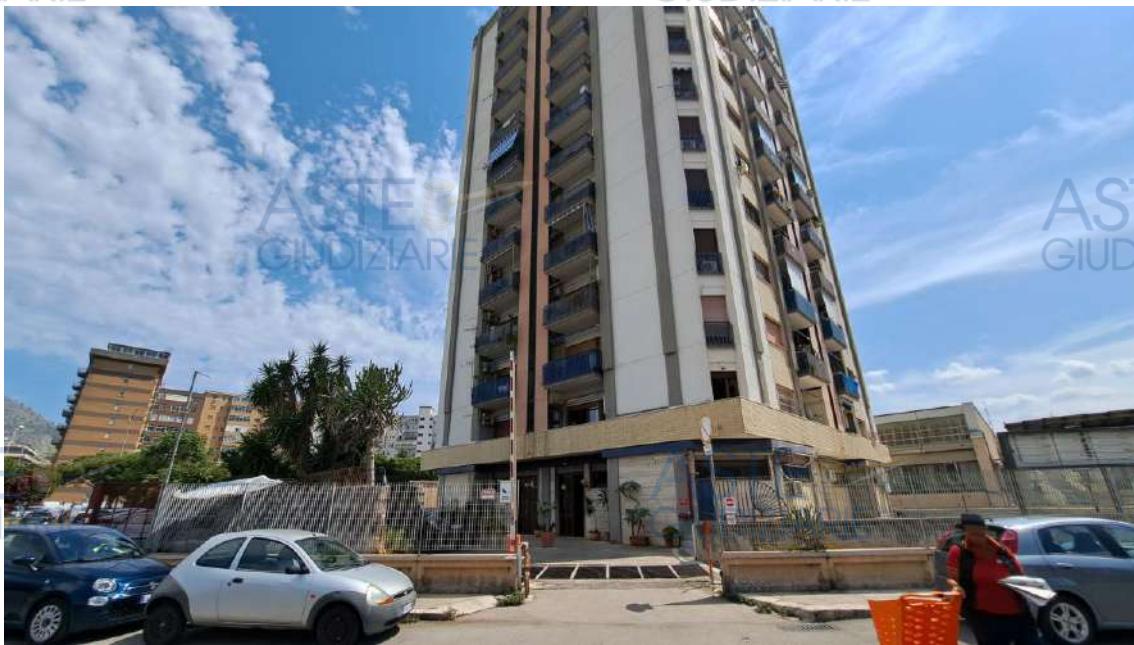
prospetto principale e laterale, spazio condominiale da cui si diparte seconda rampa carrabile di accesso al lotto C
